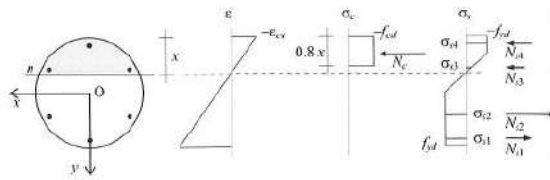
Stato deformativo e tensionale nella sezione circolare
